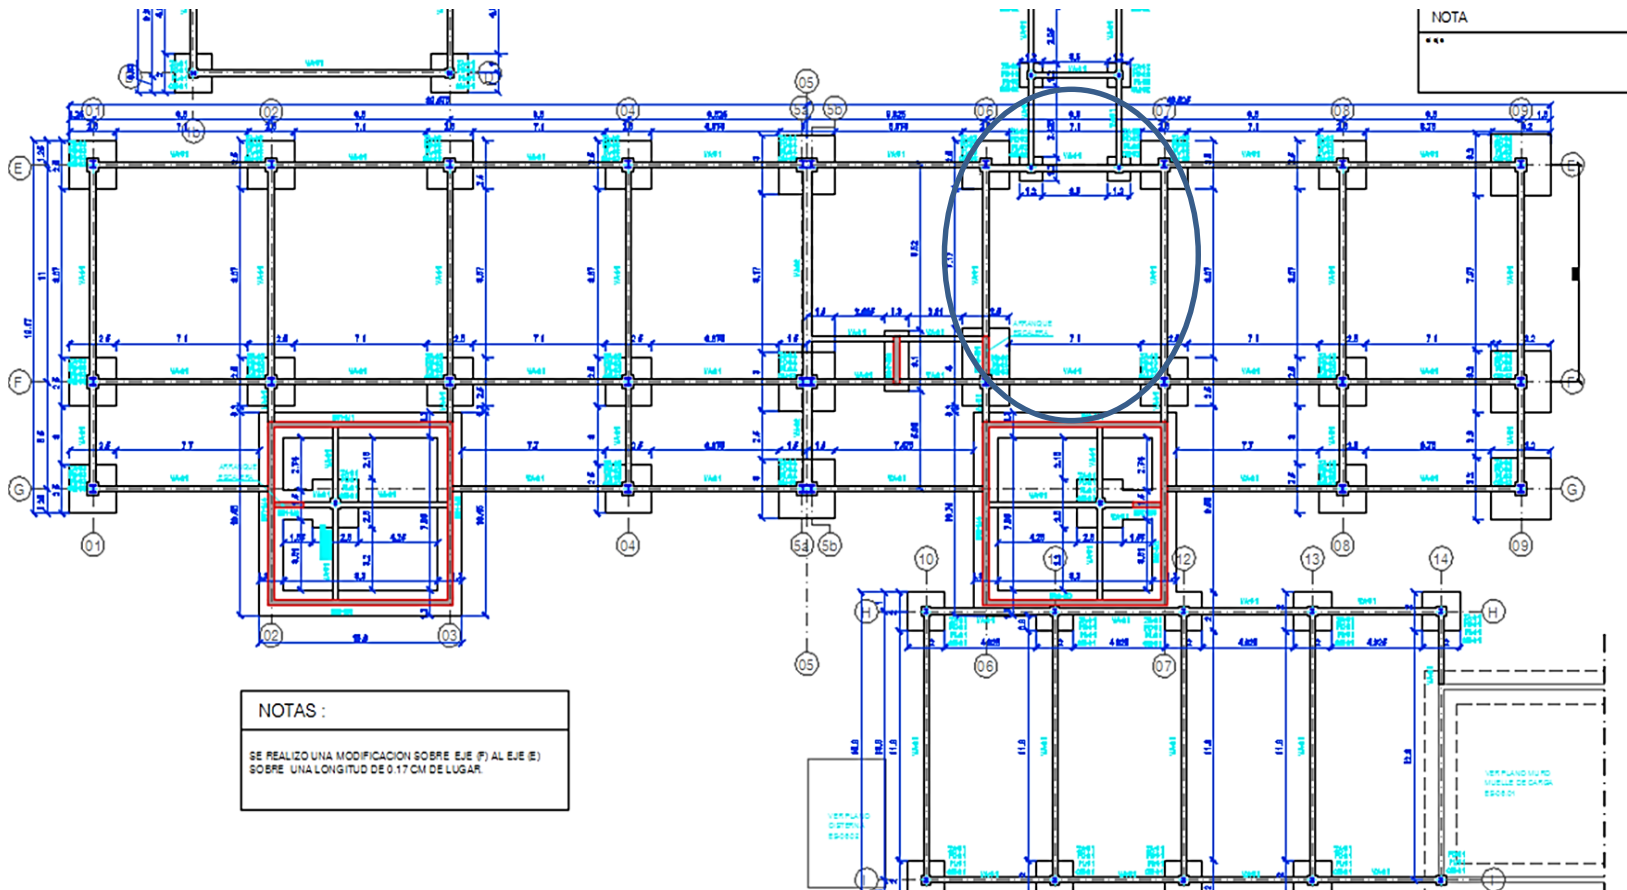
Lamina plano de fundaciones cambio entre eje F y eje E
